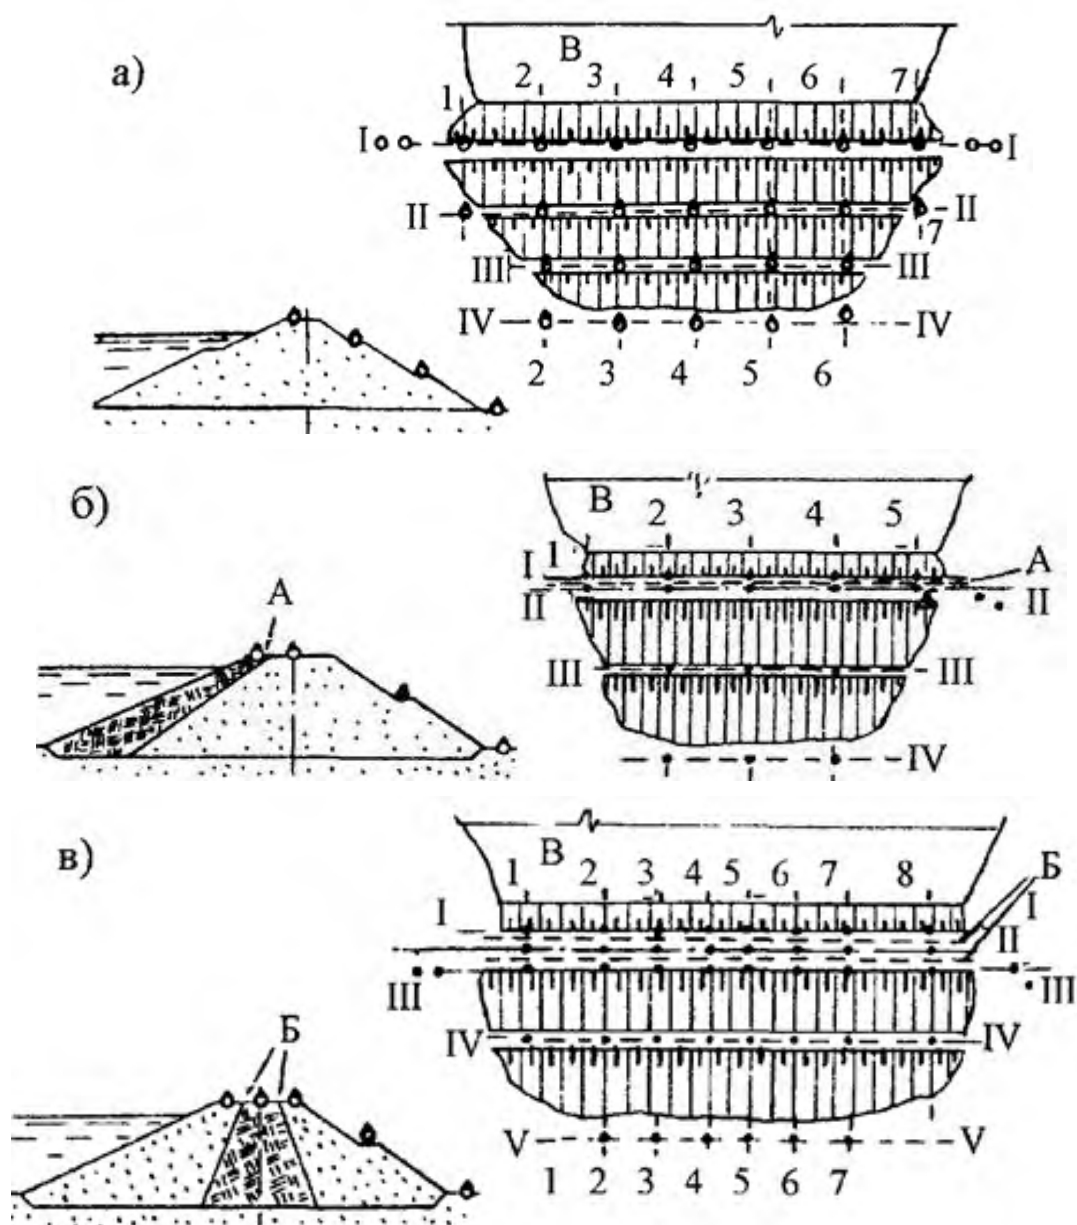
Схема расположения створов марок на грунтовых плотинах
